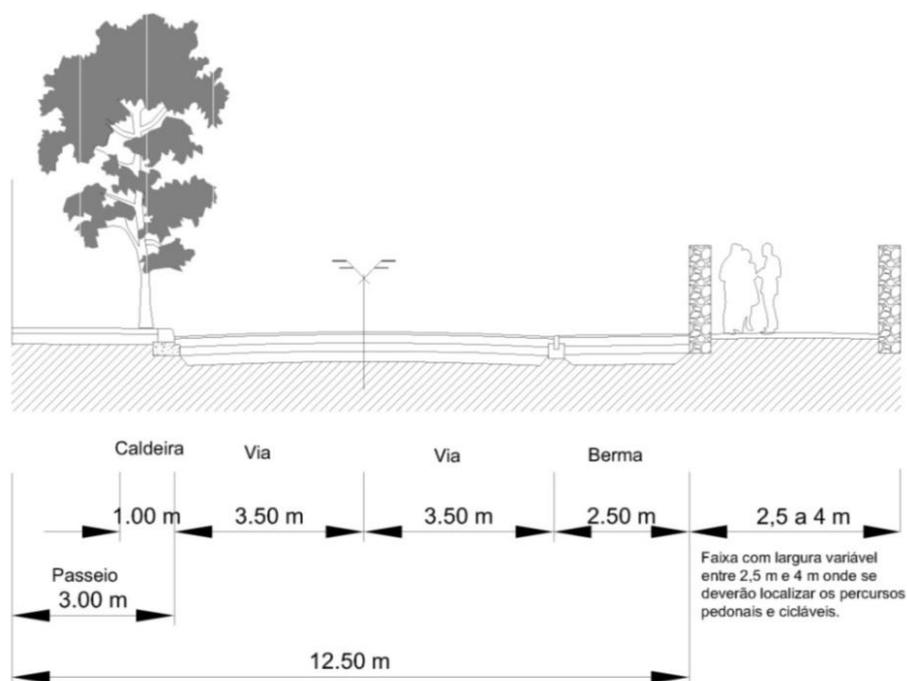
Perfil Transversal Tipo da via sul da SP 10.a
